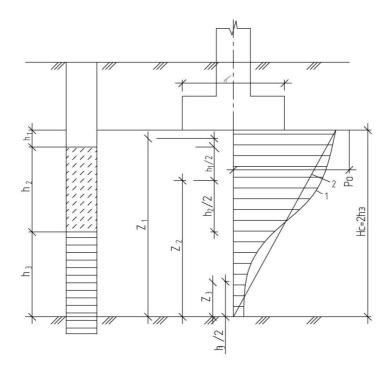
Схема к определению осадок методом эквивалентного слоя для многослойного основания: 1 — расчётная нелинейная эпюра дополнительных напряжений; 2 — эквивалентная треугольная эпюра дополнительных напряжений
